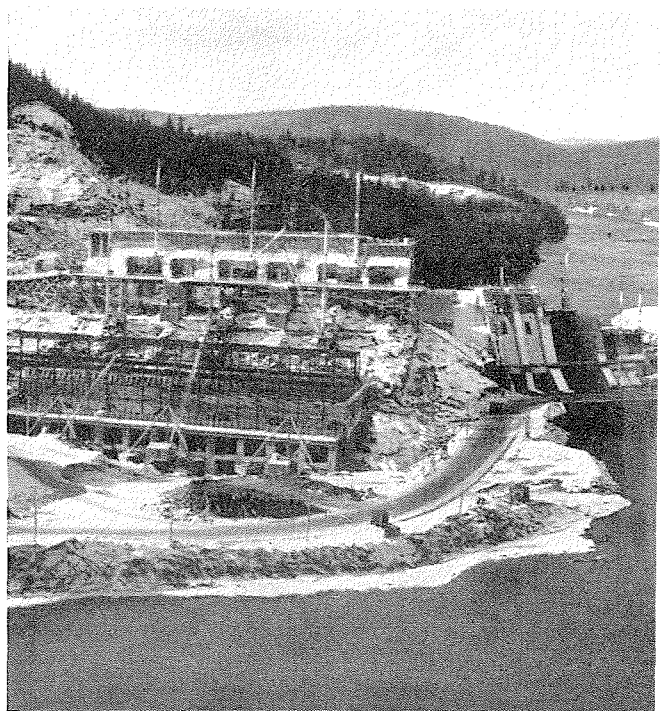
Vue générale, vers l'amont, de la chute de Trenché au cours de la construction (février 1950).
